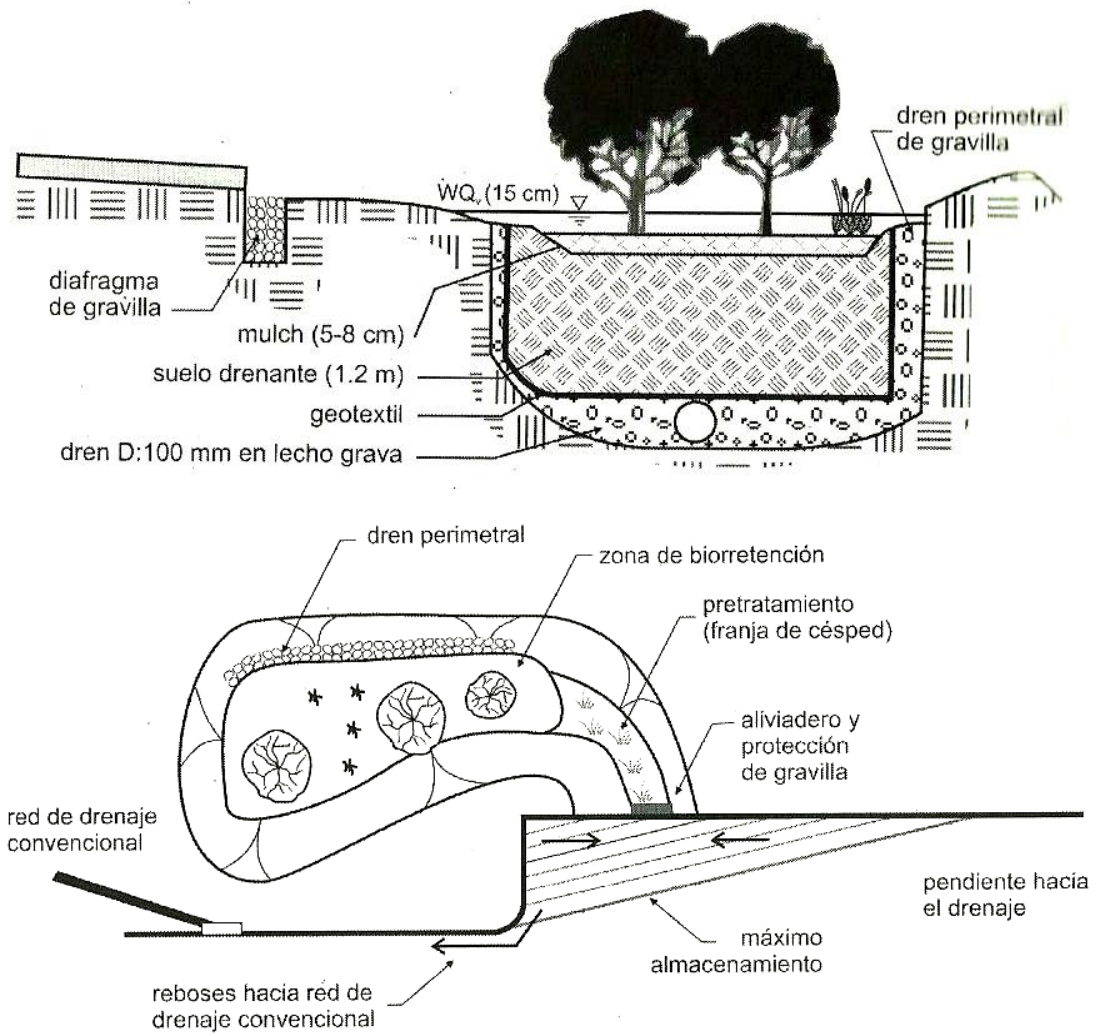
Esquema de la planta y el perfil de un área de biorretención. Fuente: CEDEX (2008).
